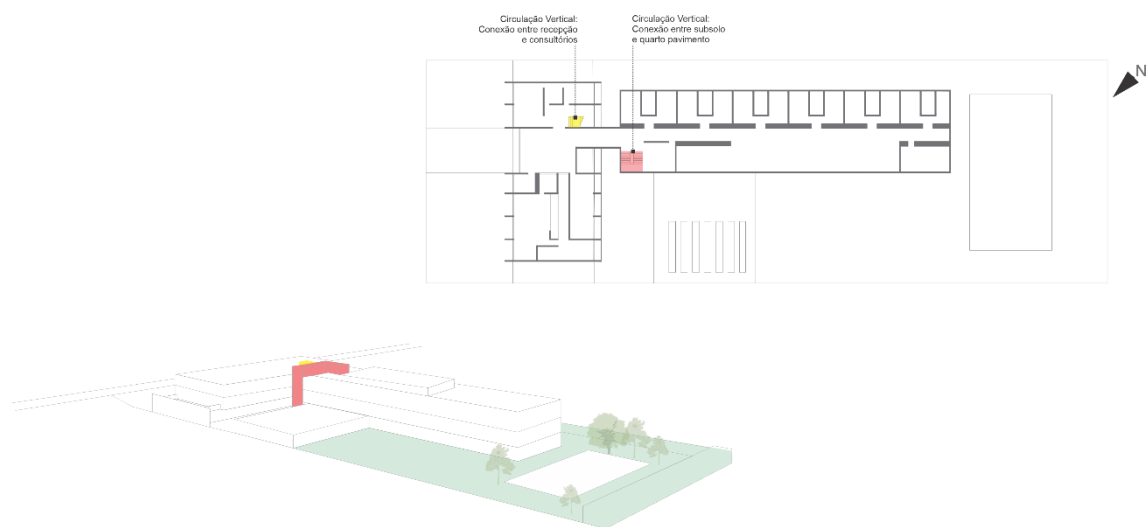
Planta do pav. térreo da CP com ênfase na circulação vertical
